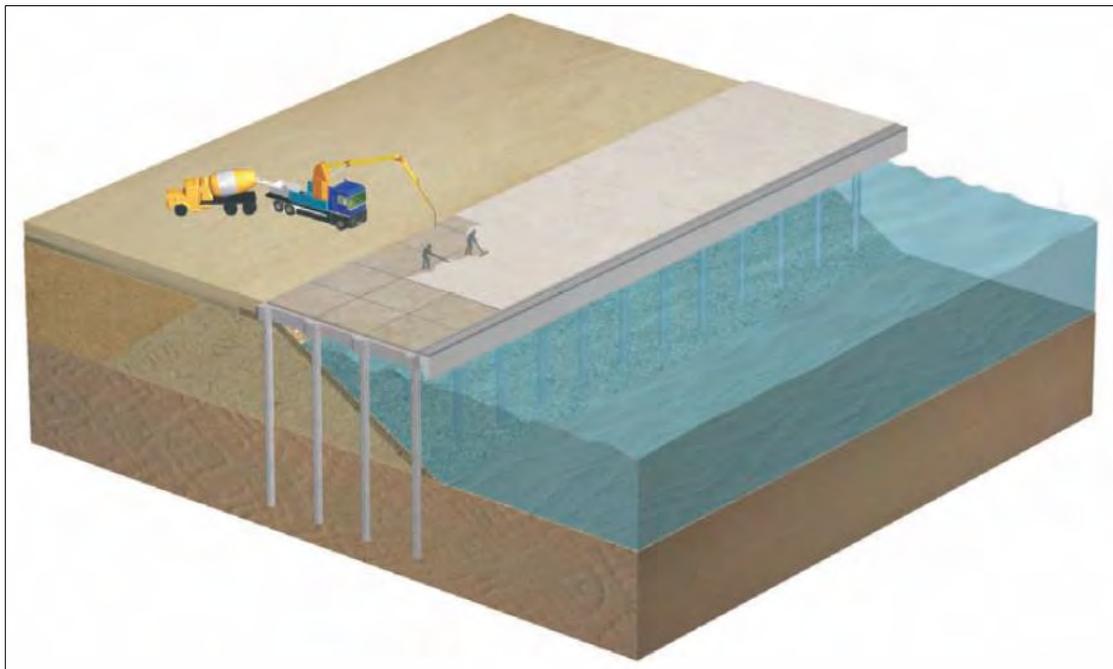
Ejemplo del vaciado de concreto premezclado.
